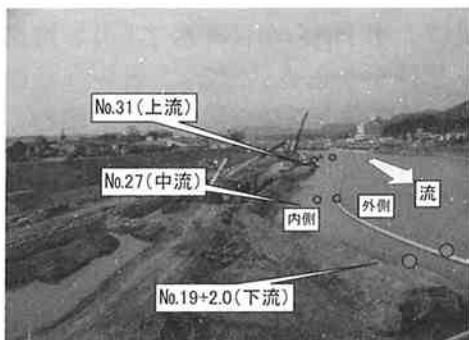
水質測定位置と汚濁防止フェンスの設置状況
